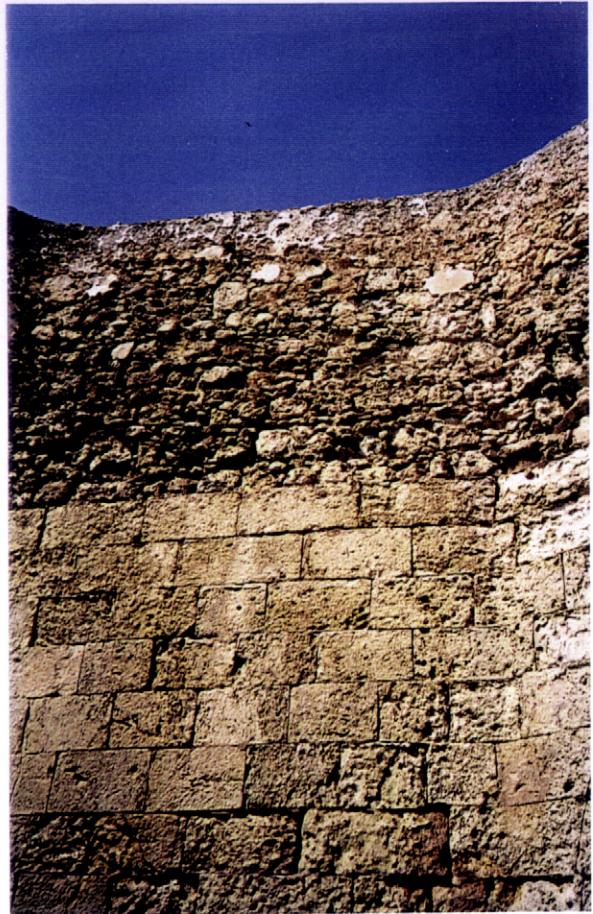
Alvenarias de pedra na zona da calheta na fachada Nascente/marítima – Setembro de 2000.
